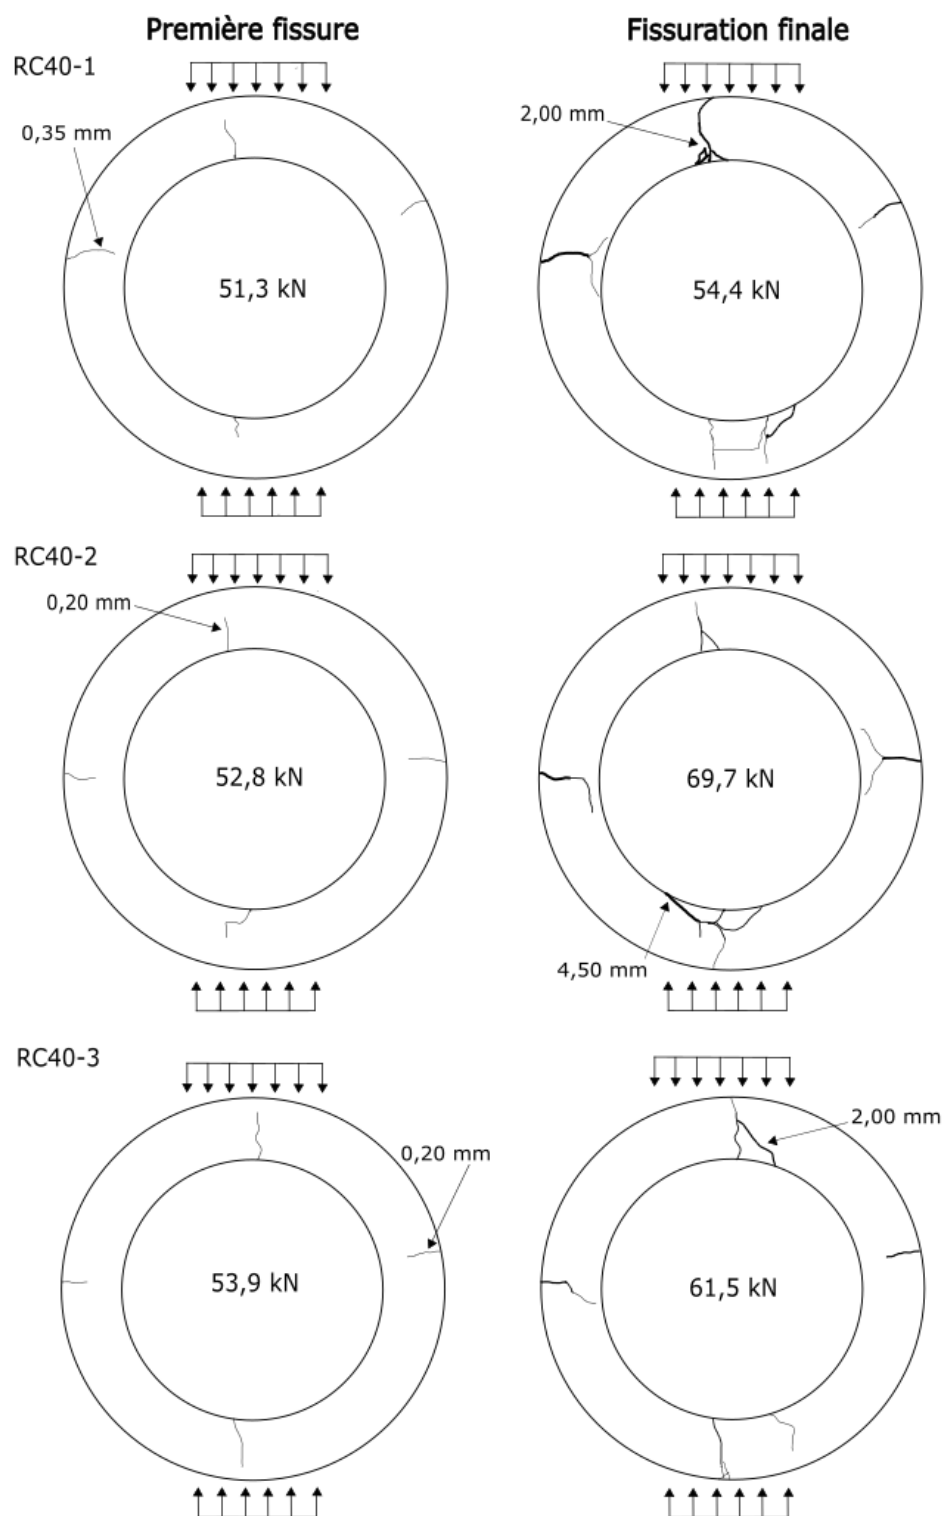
Premières fissures et fissuration finale des sections de tuyaux avec 40% de RB
